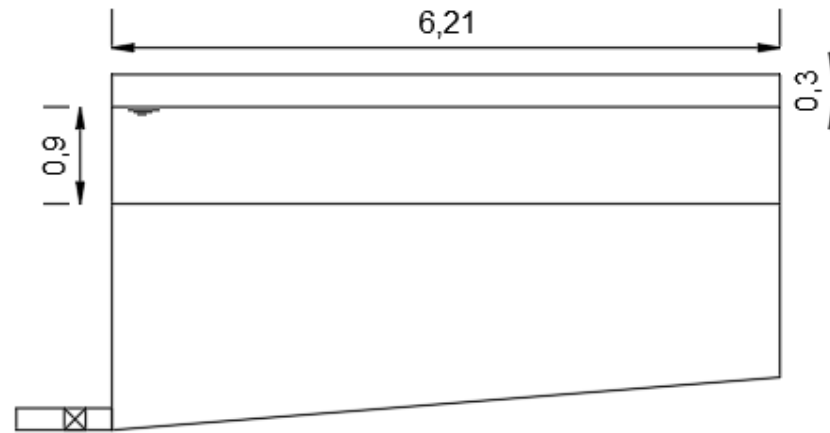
Corte longitudinal B-B de las estructuras hidráulicas, tomada de software AutoCAD.
